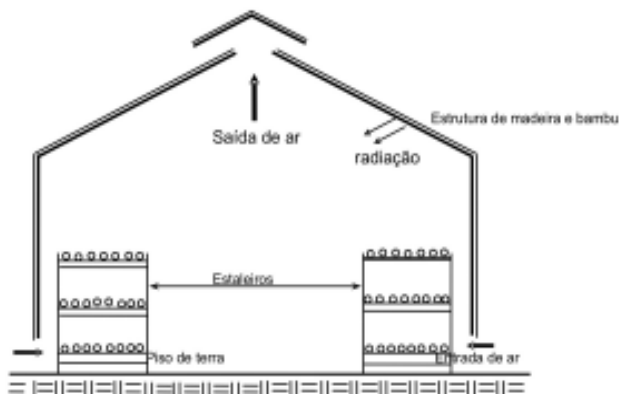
Estufa. Corte Transversal. S/escala.
